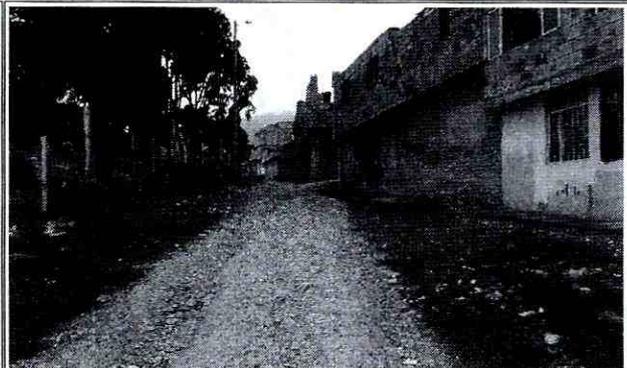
Vista de la Calle 89 C Sur Barrio Progreso II Sector la Reforma – Enero 2017
